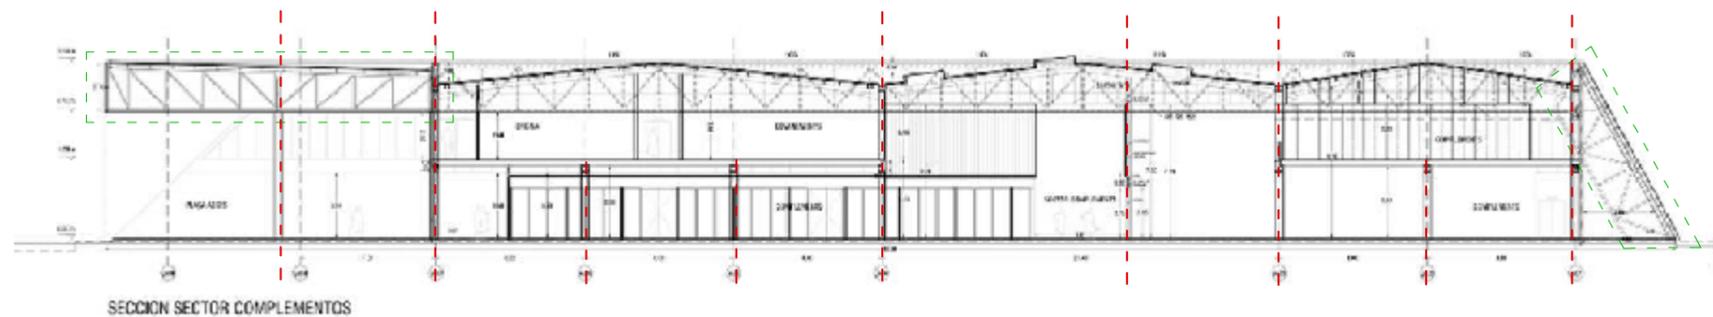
Vista interna/ estructura m ercado de flores-Mercabarna
